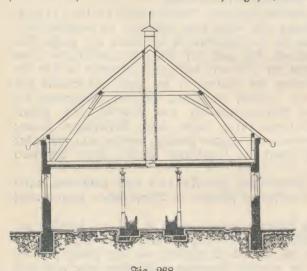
Durchschnitt durch einen Rindviehstall mit gemeinsamem Futtergang, Kniestock und liegendem Dachstuhl. (Maßstab 1: 200.)
